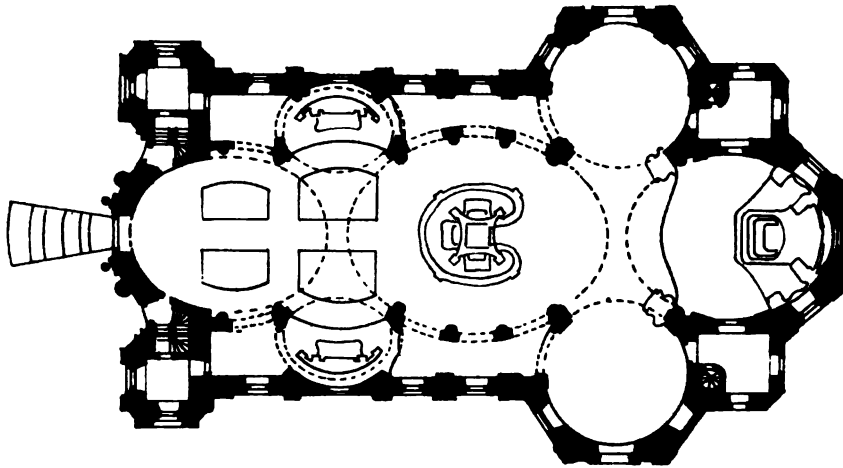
Grundriss der Kirche zu Vierzehnheiligen
